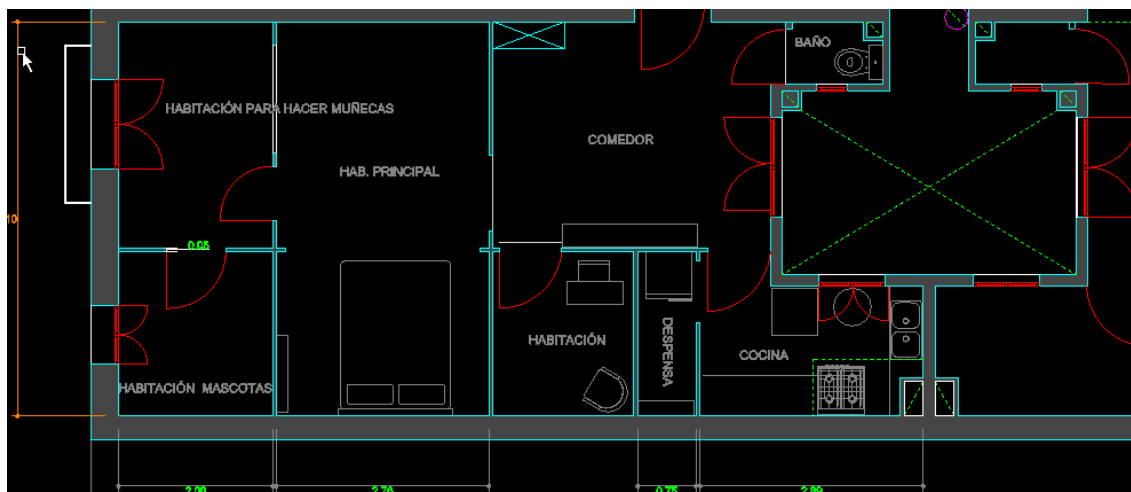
Vista en planta distribución viviendas 2º y 4º piso
